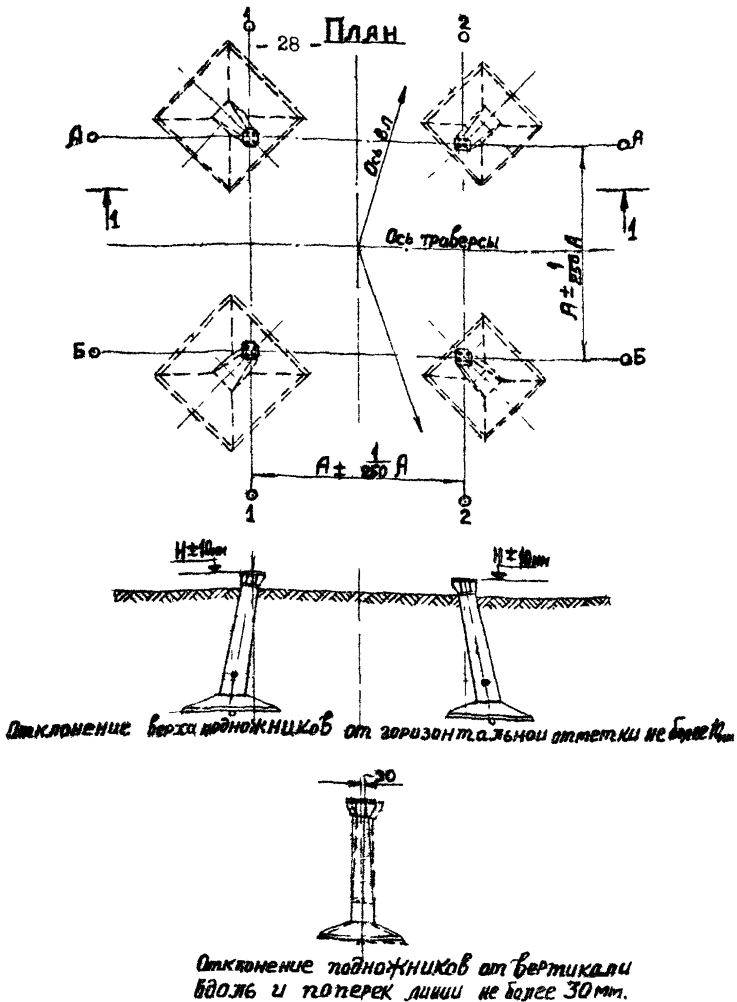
Нормы и допуски на установку фундаментов из унифицированных железобетонных элементов под металлические опоры
